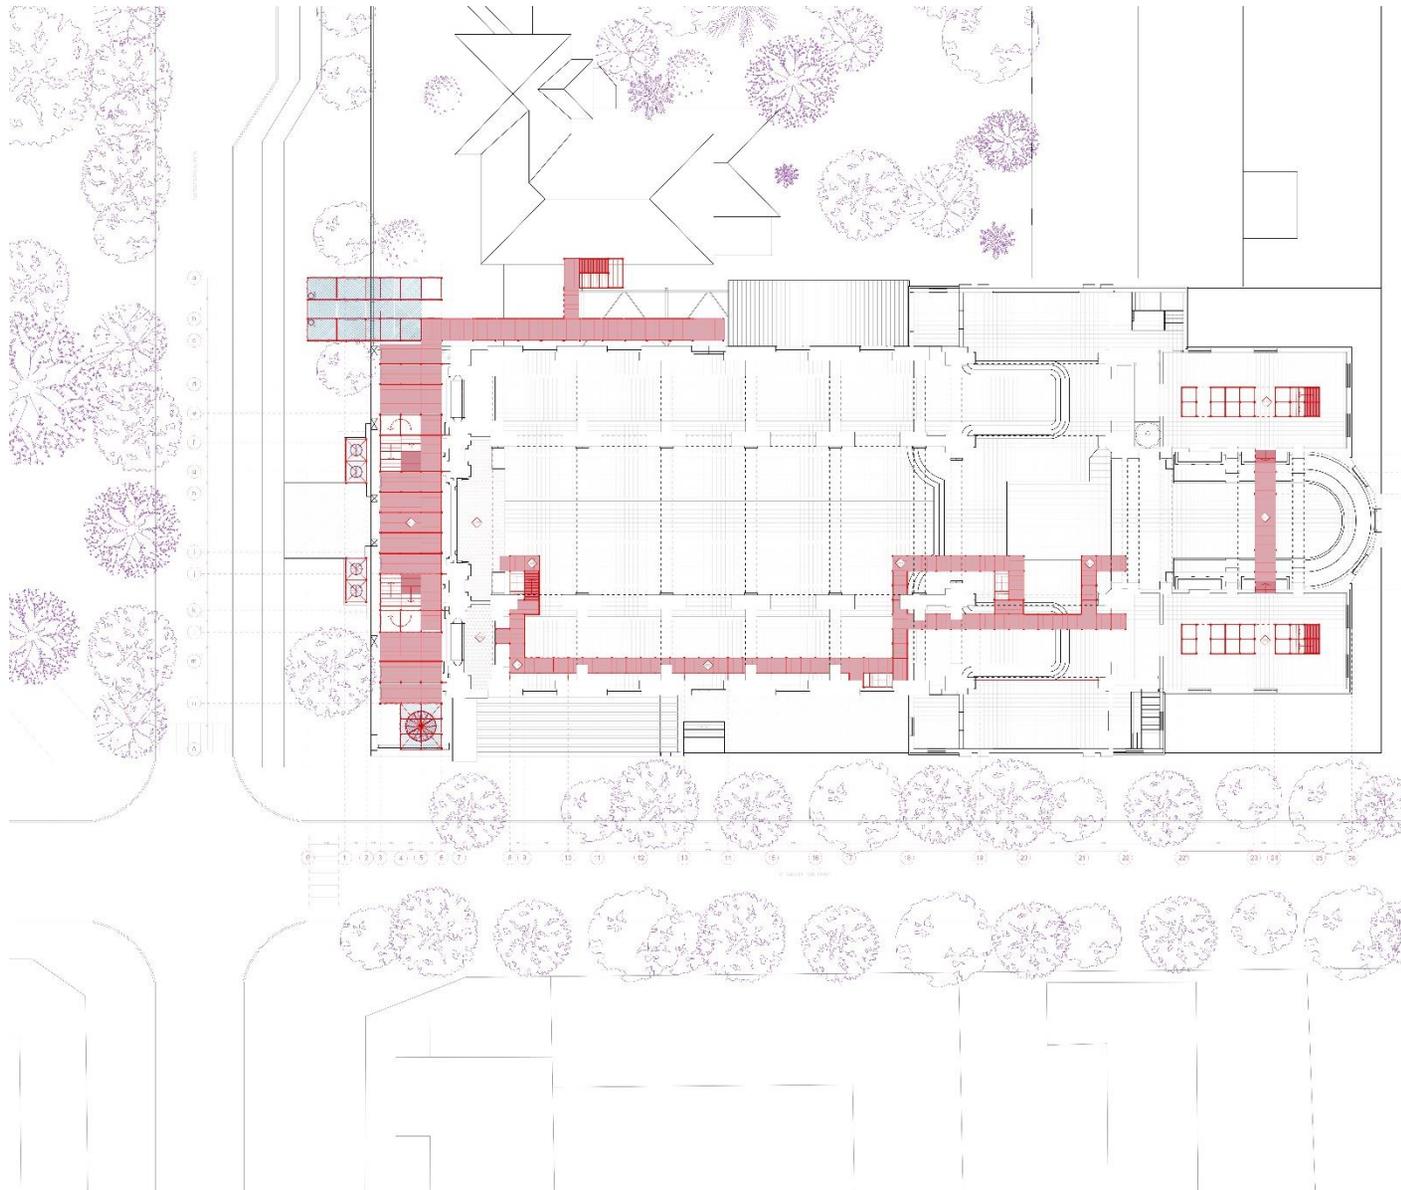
Planimetría proyecto segundo nivel. Elaboración propia
